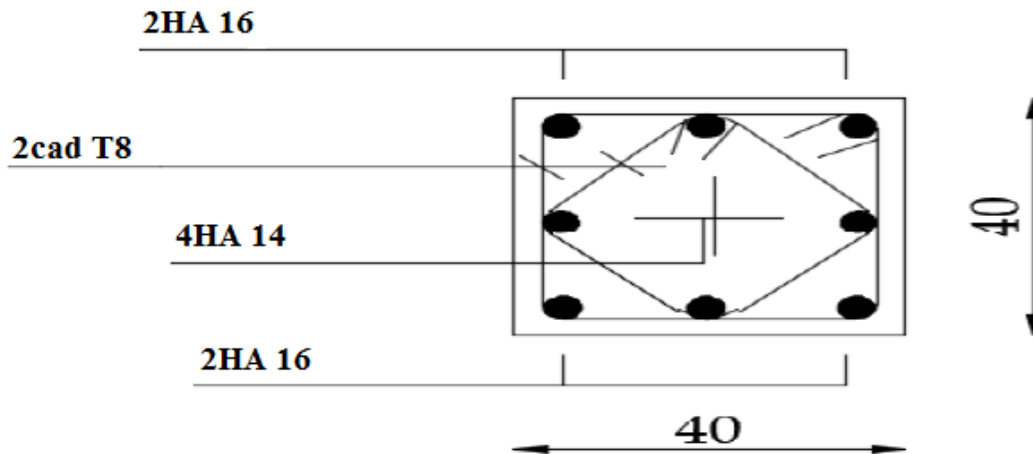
Schéma de ferrailage des poteaux (40 × 40)
